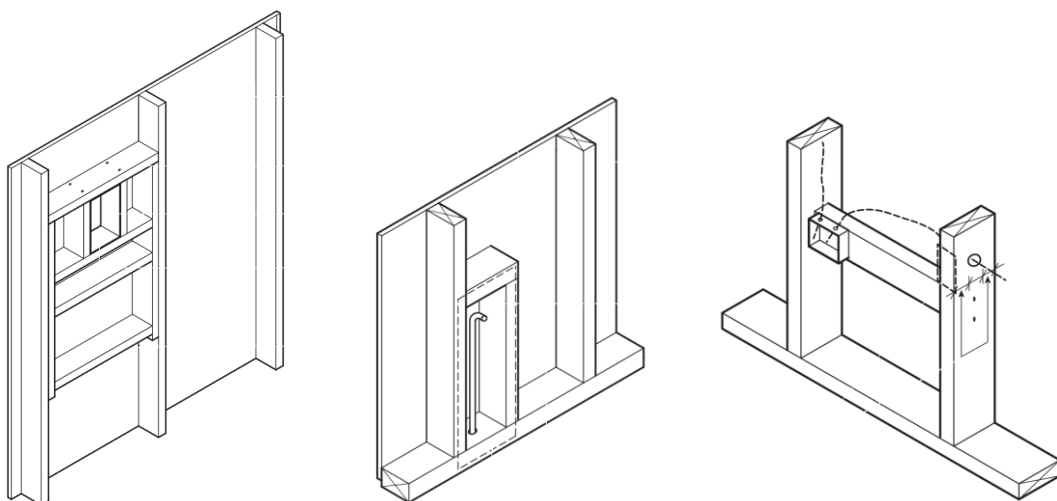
Exemplos de montantes e travamentos adicionais para suporte das instalações no interior do *timber-frame
